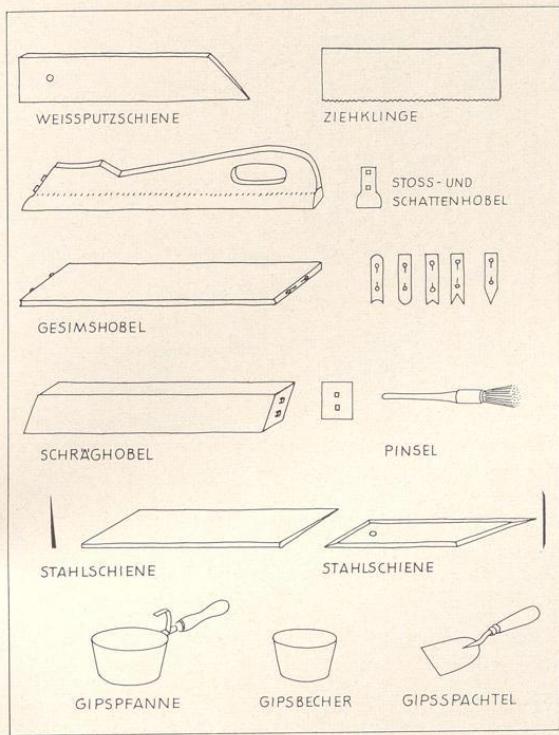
Werkzeuge zum Zuschneiden der Gesimsecken
